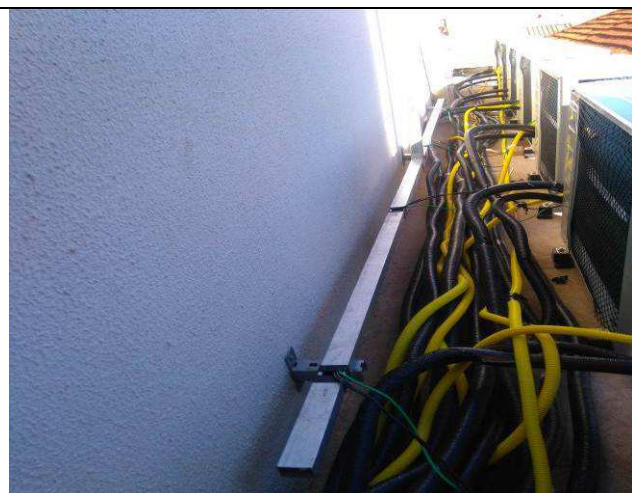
E: Infraestrutura perfilados - alimentação condensadoras 1º pavimento.
